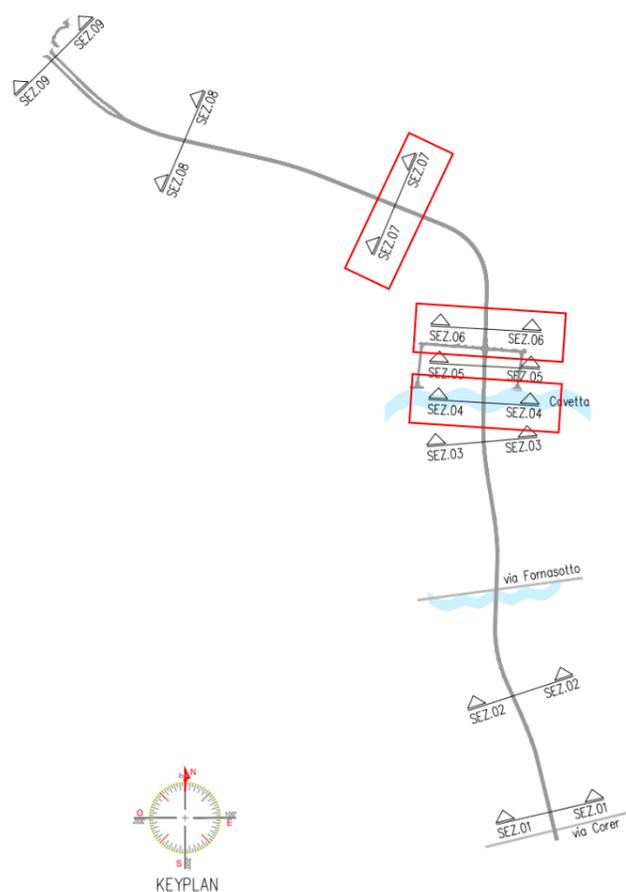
Keyplan delle sezioni territoriali: sono evidenziate quelle proposte di seguito (fonte: 1370.0.F.P.002.0.D.0_Allegato RP).
